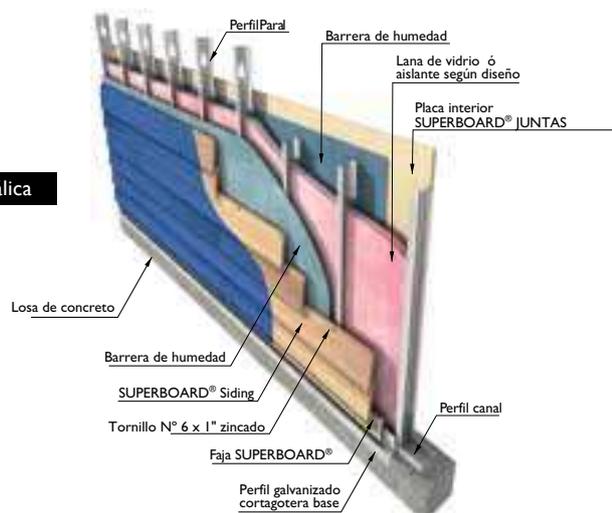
Detalles de solución de fachada en Superboard Siding® con varios elementos constructivos
